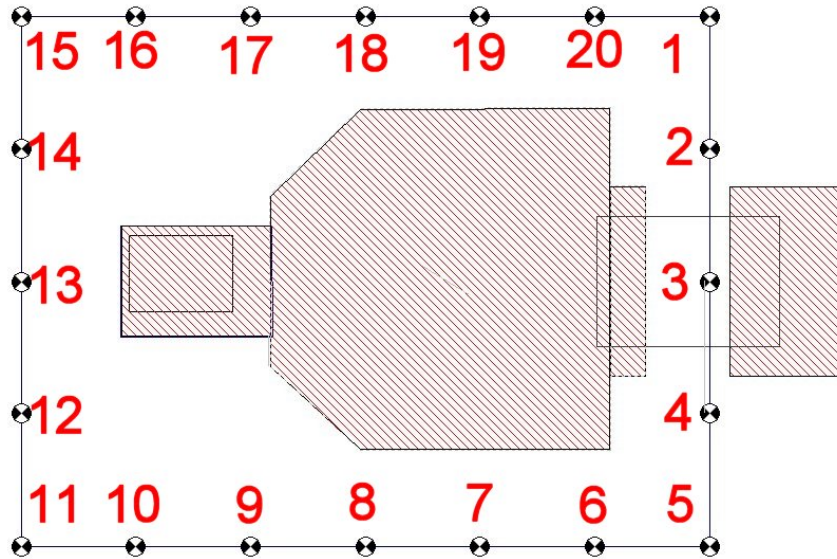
Messpunktachsen 1 bis 20 im Grundriss
